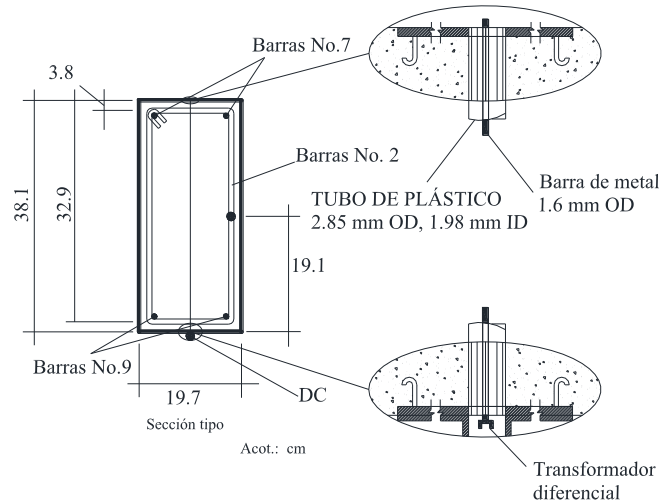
Instrumentación y detalles de viga, serie WD, Seabold (1967).
